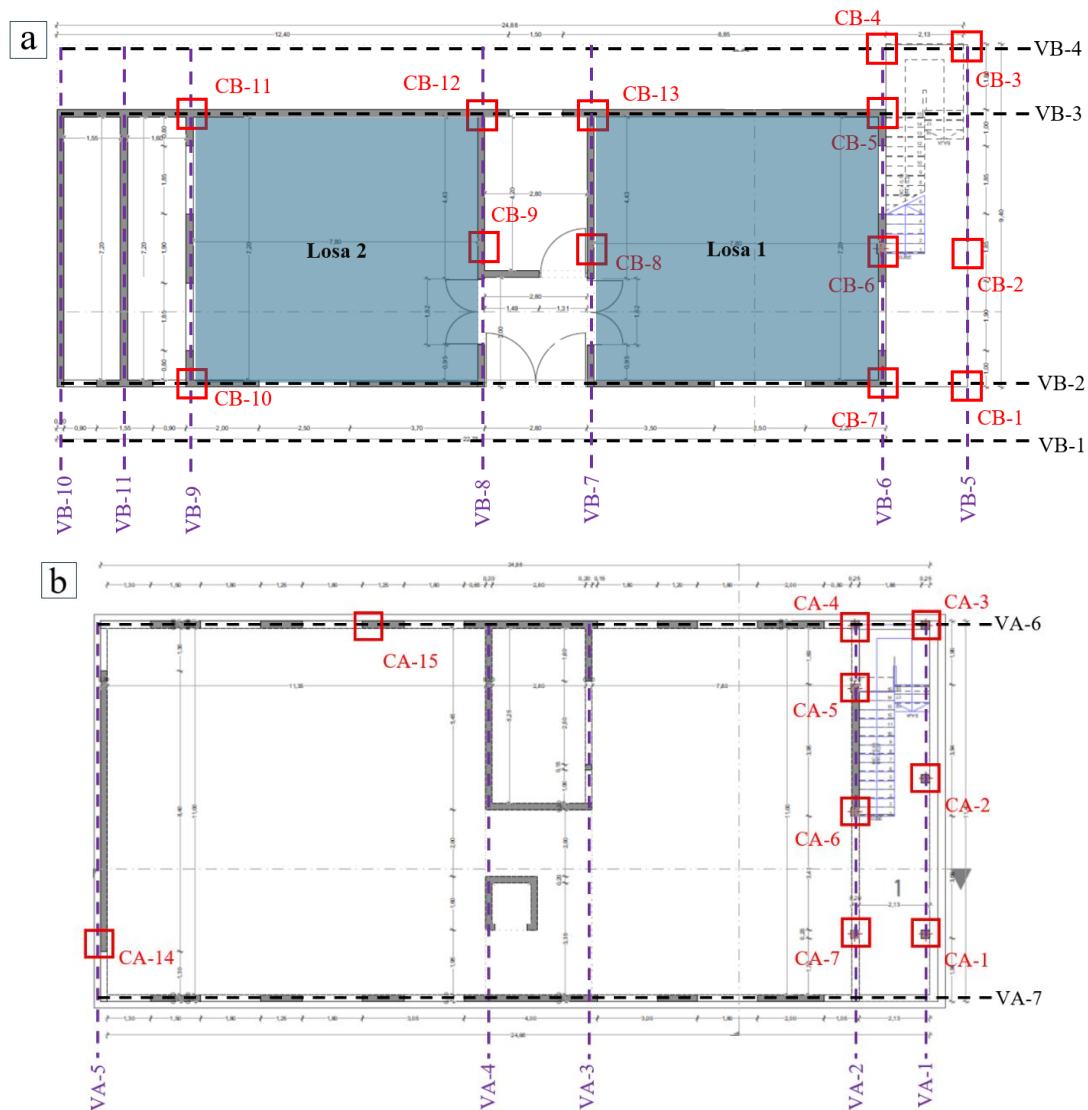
Planos de la edificación: (a) planta baja y (b) planta alta.
